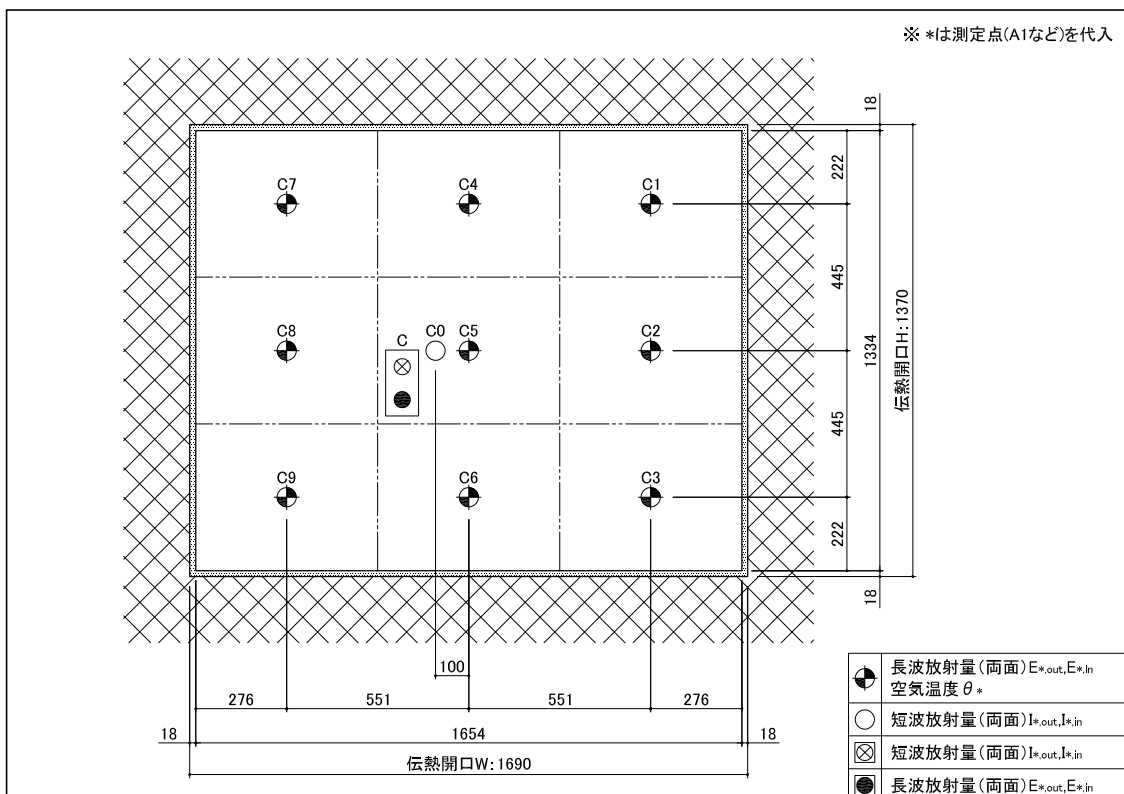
センサー配置図 (室内, Section C, ※内観を示す)
